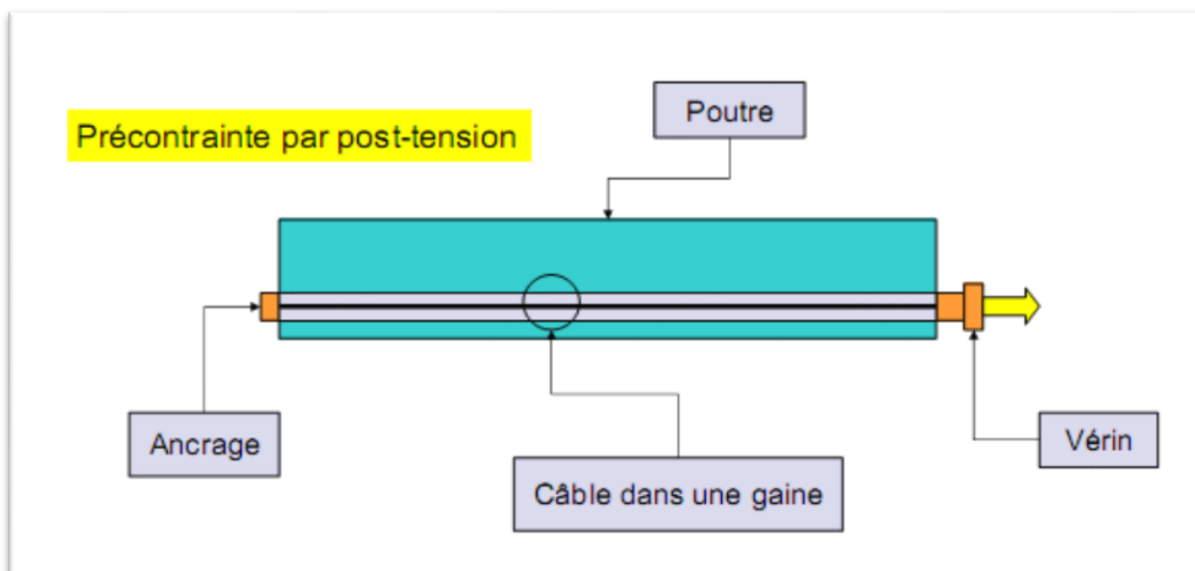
Coupe longitudinale d'une poutre en béton précontraint par post tension
